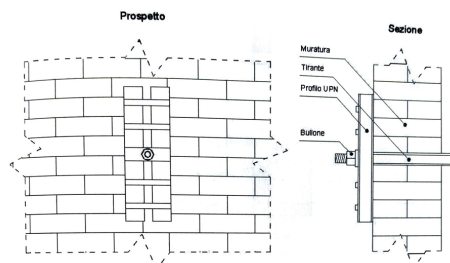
Capochiave con profili UPN in prospetto e sezione.
